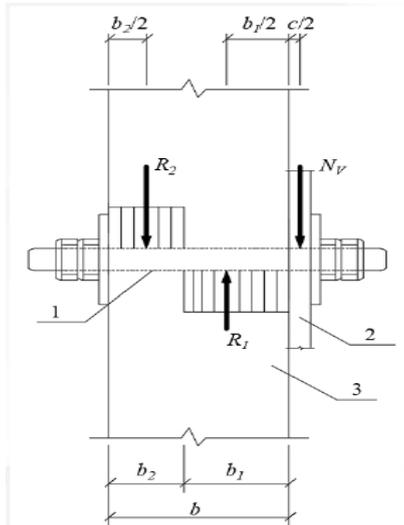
附着螺栓孔处混凝土受压状况图
